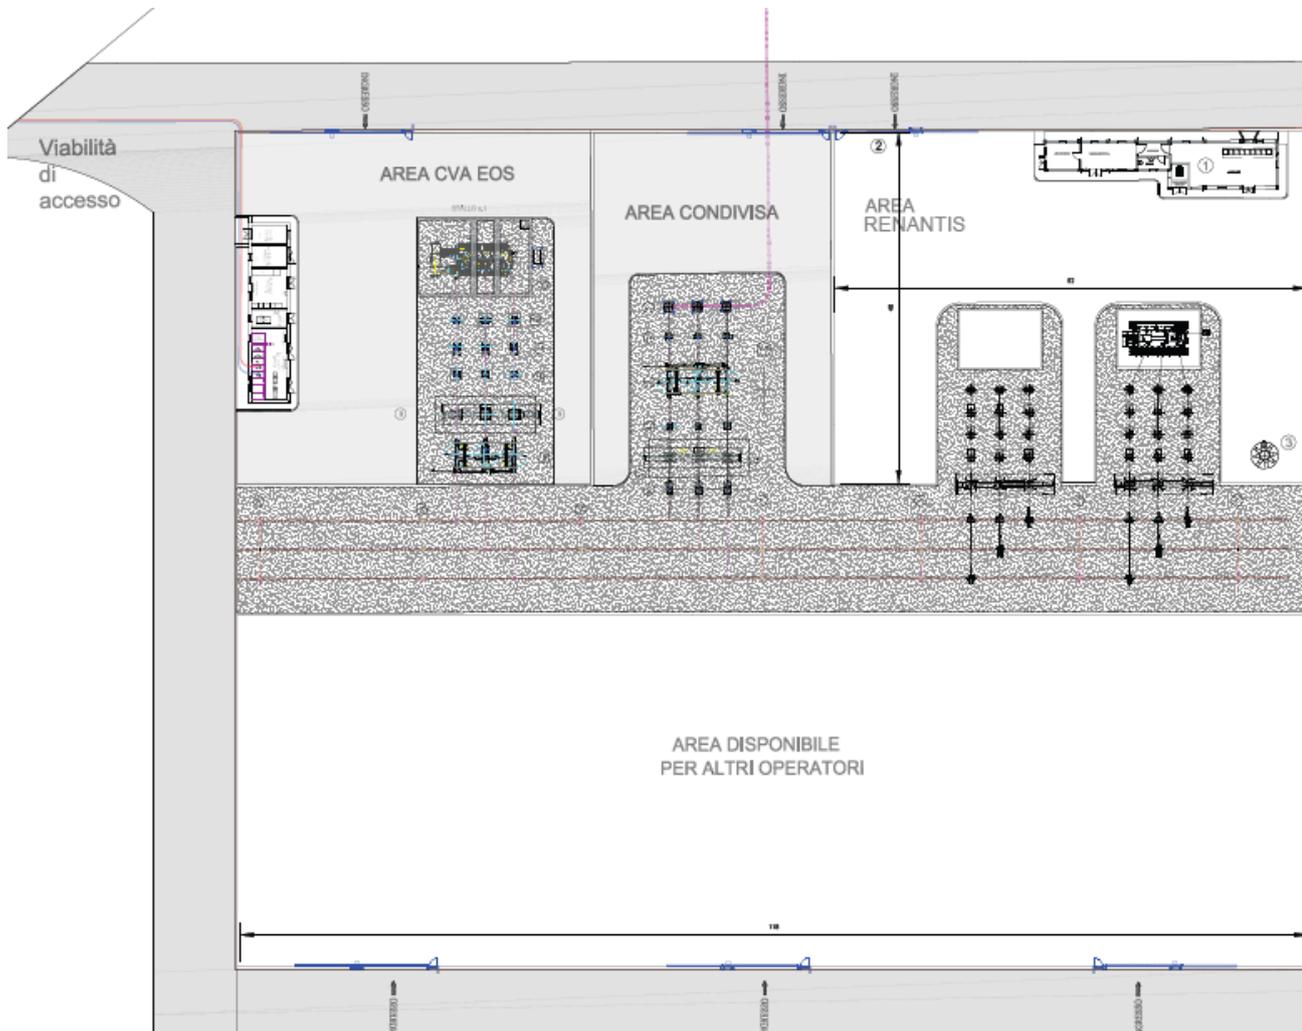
Planimetria elettromeccanica della nuova configurazione di Stazione Elettrica di Utenza
